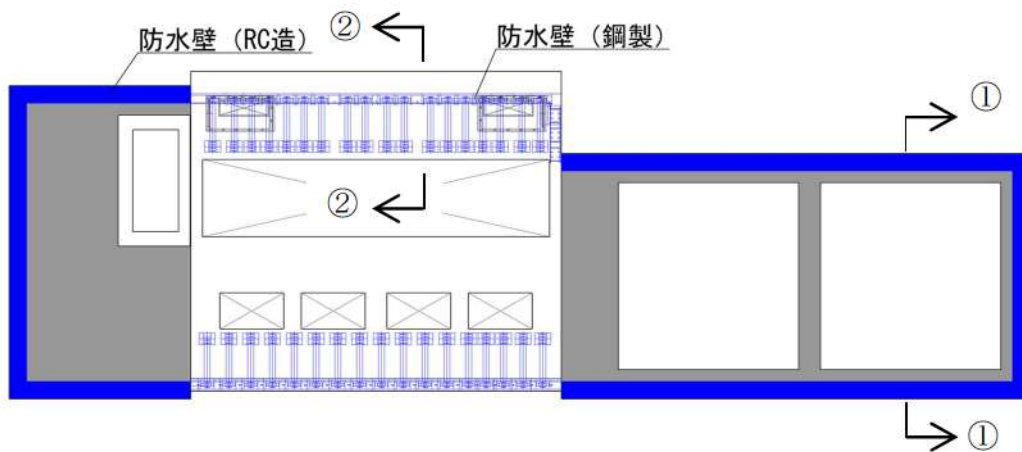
3号炉取水ピットスクリーン室防水壁 平面図
